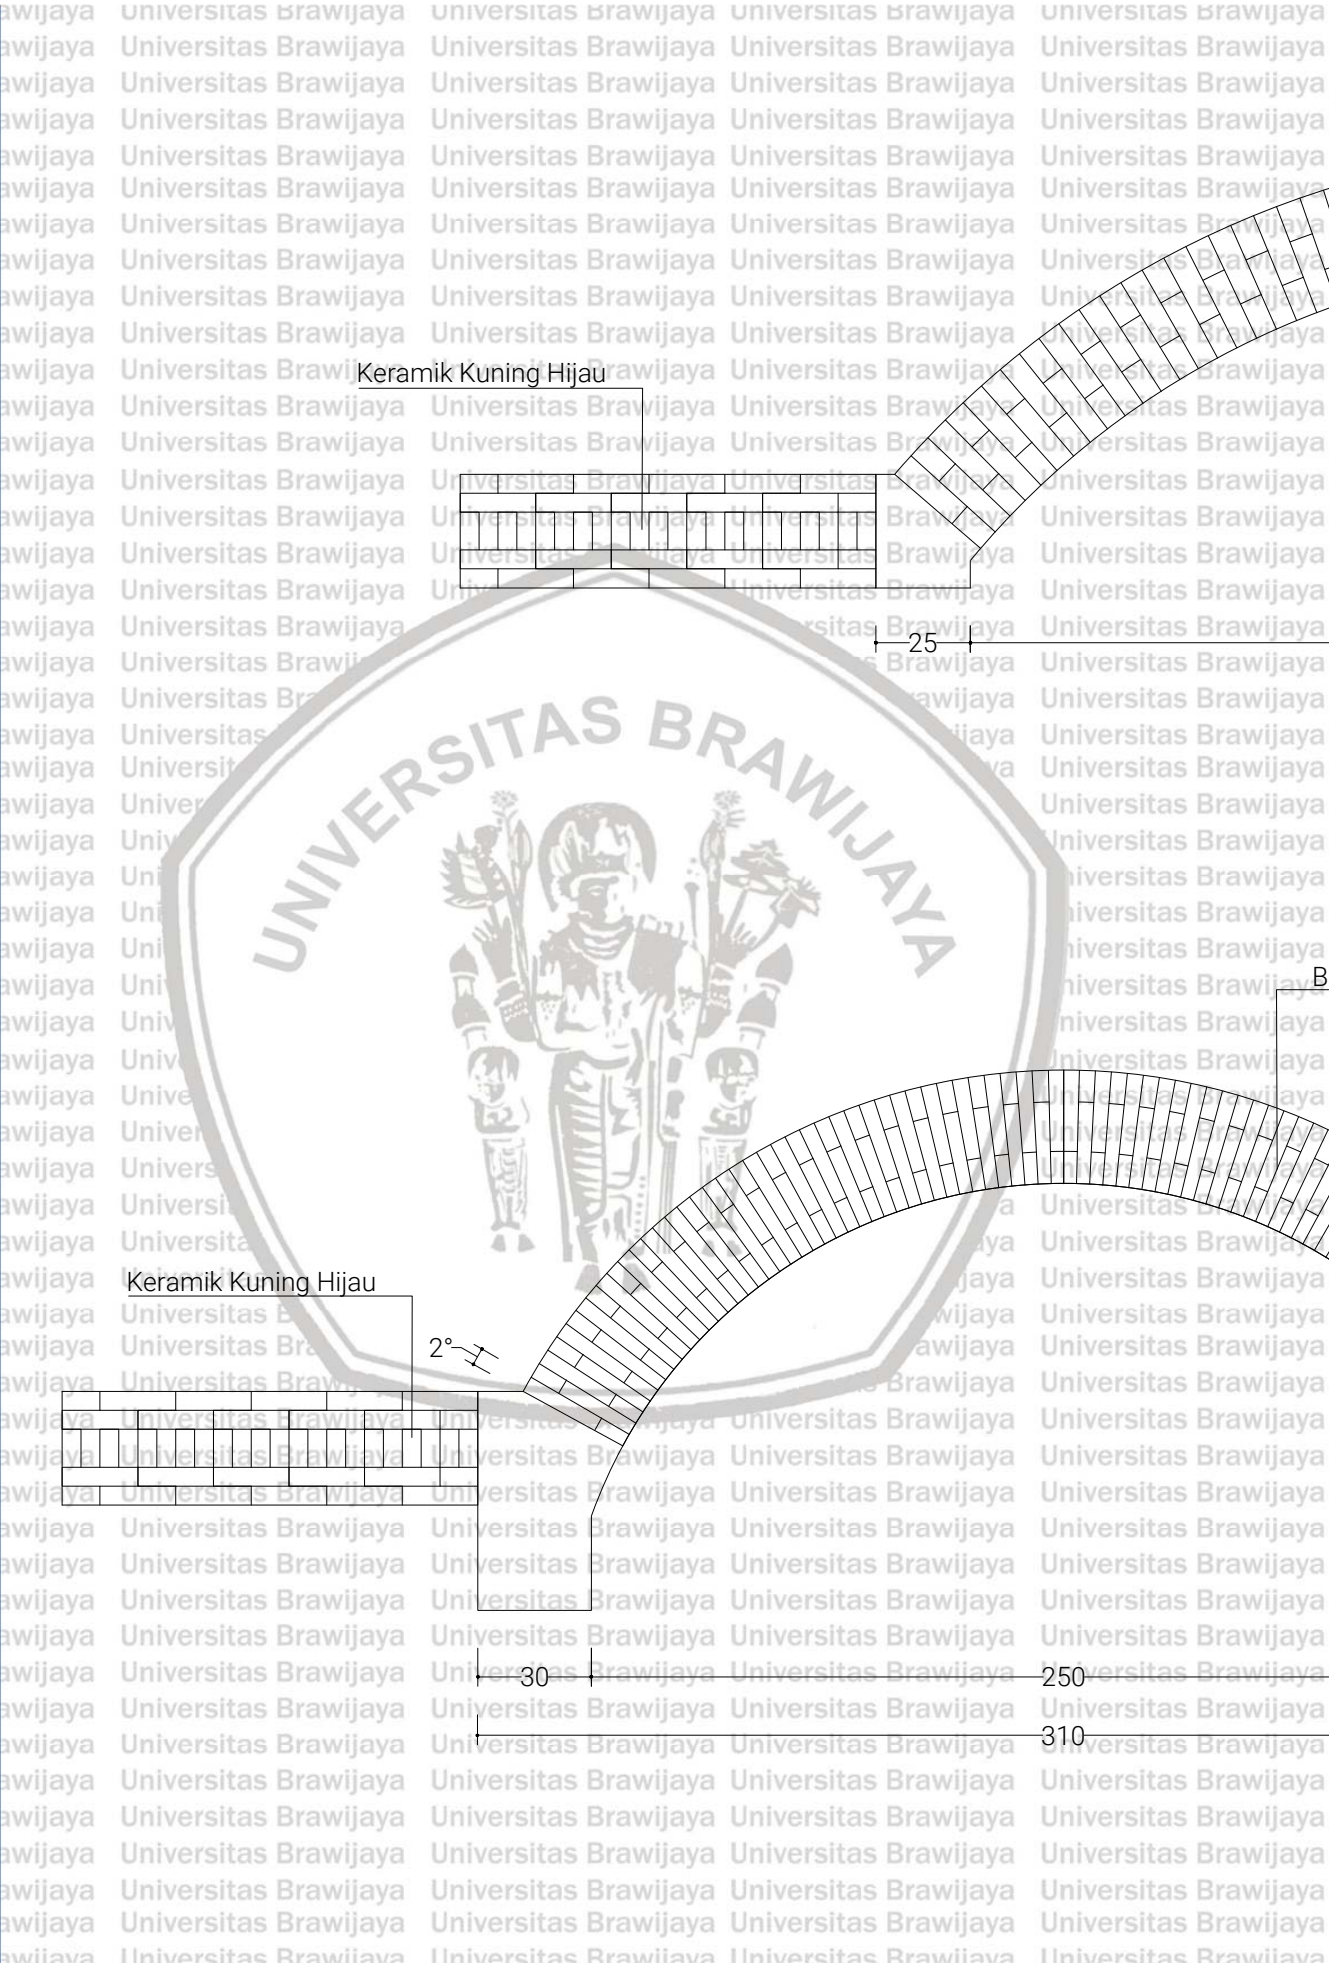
DETAIL JENDELA ATAS 1 STASIUN TAWANG
